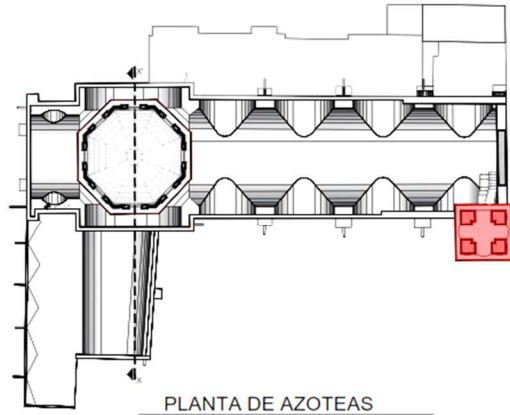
colocación de barandales en escalera, disgregación de aplanados y grietas en campanario en el lado norte.
